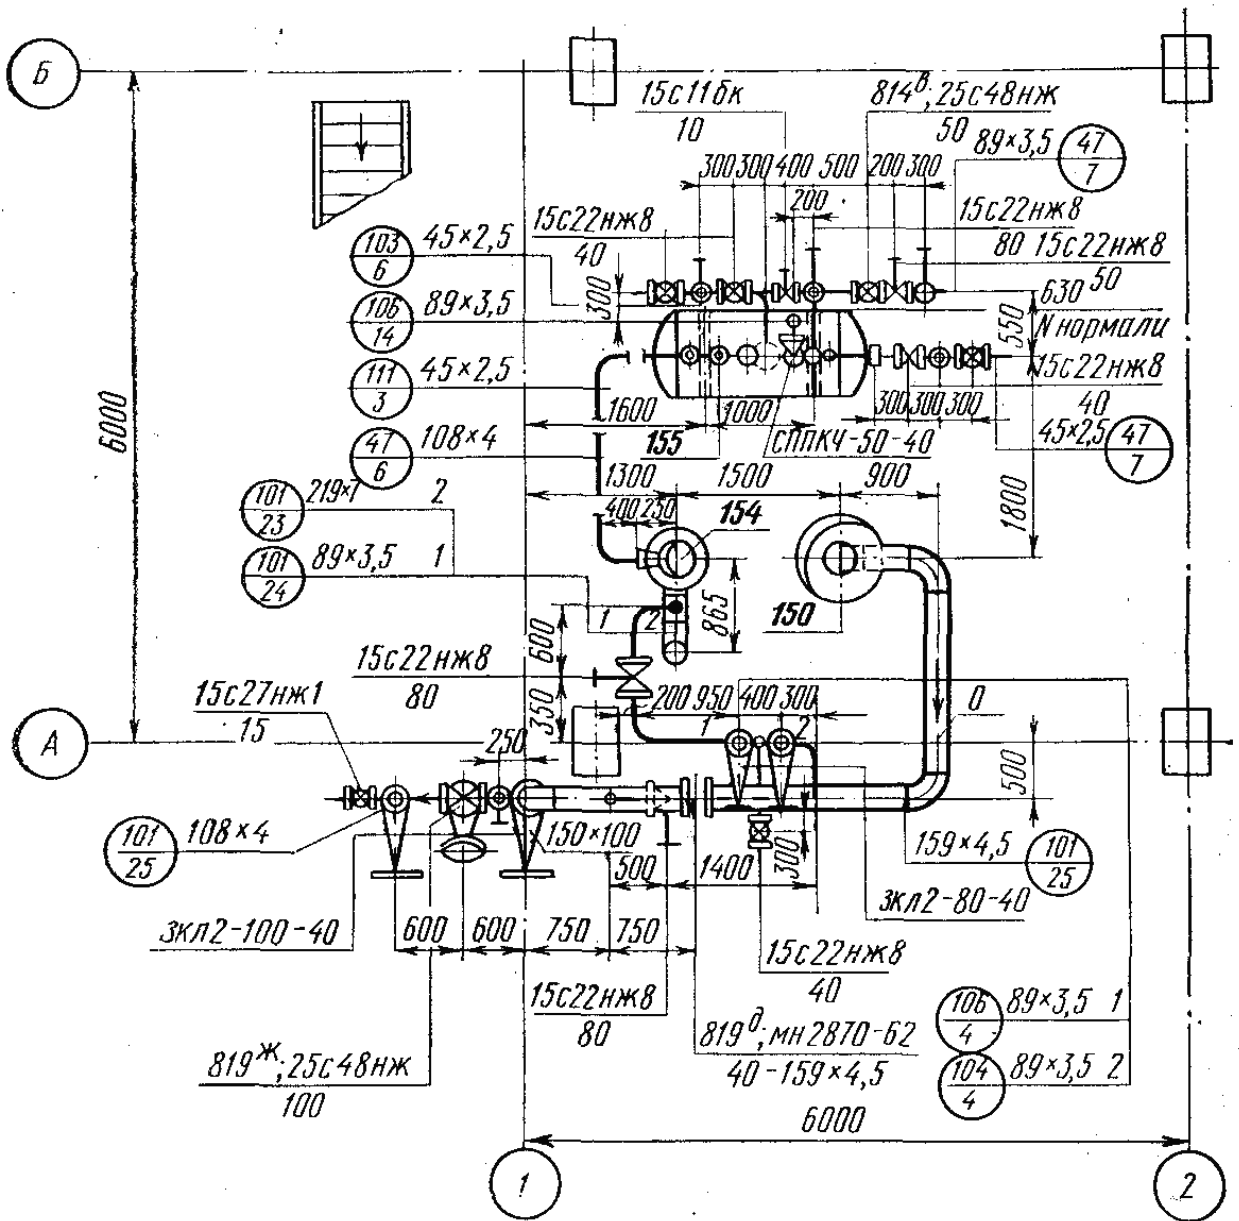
Монтажный чертеж (план) внутрицехового трубопровода
